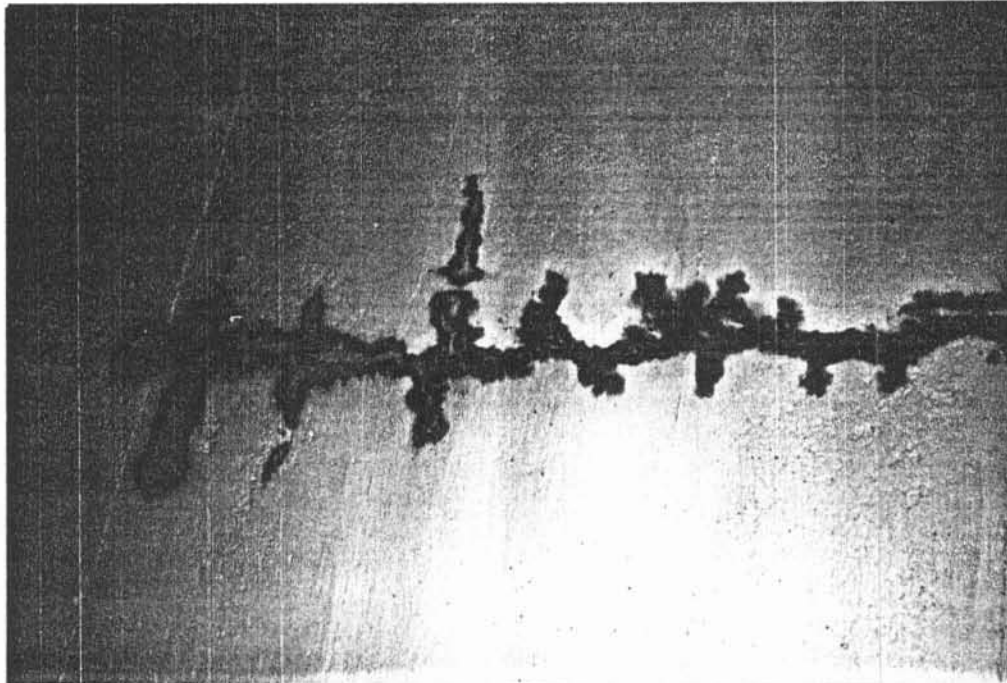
Mancha de óxido na superfície do concreto pela falta de estanqueidade provocada pela fissuração.
